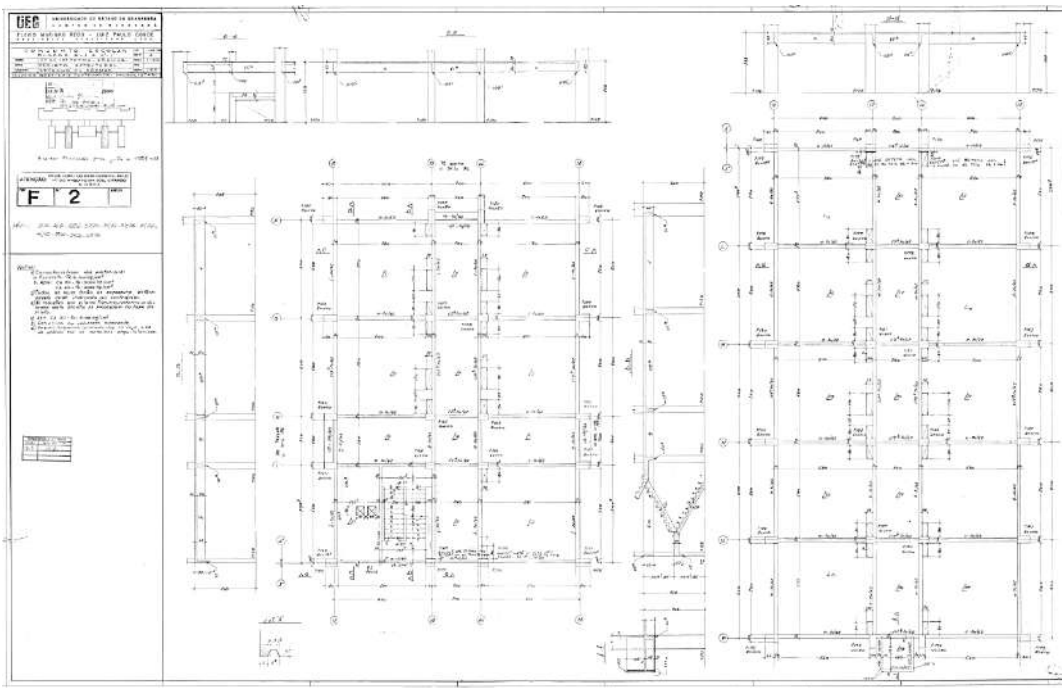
UERJ. Conjunto Escolar. Pavimento Tipo. Planta de Fôrmas dos Tetos Tipo. Blocos H,I.
